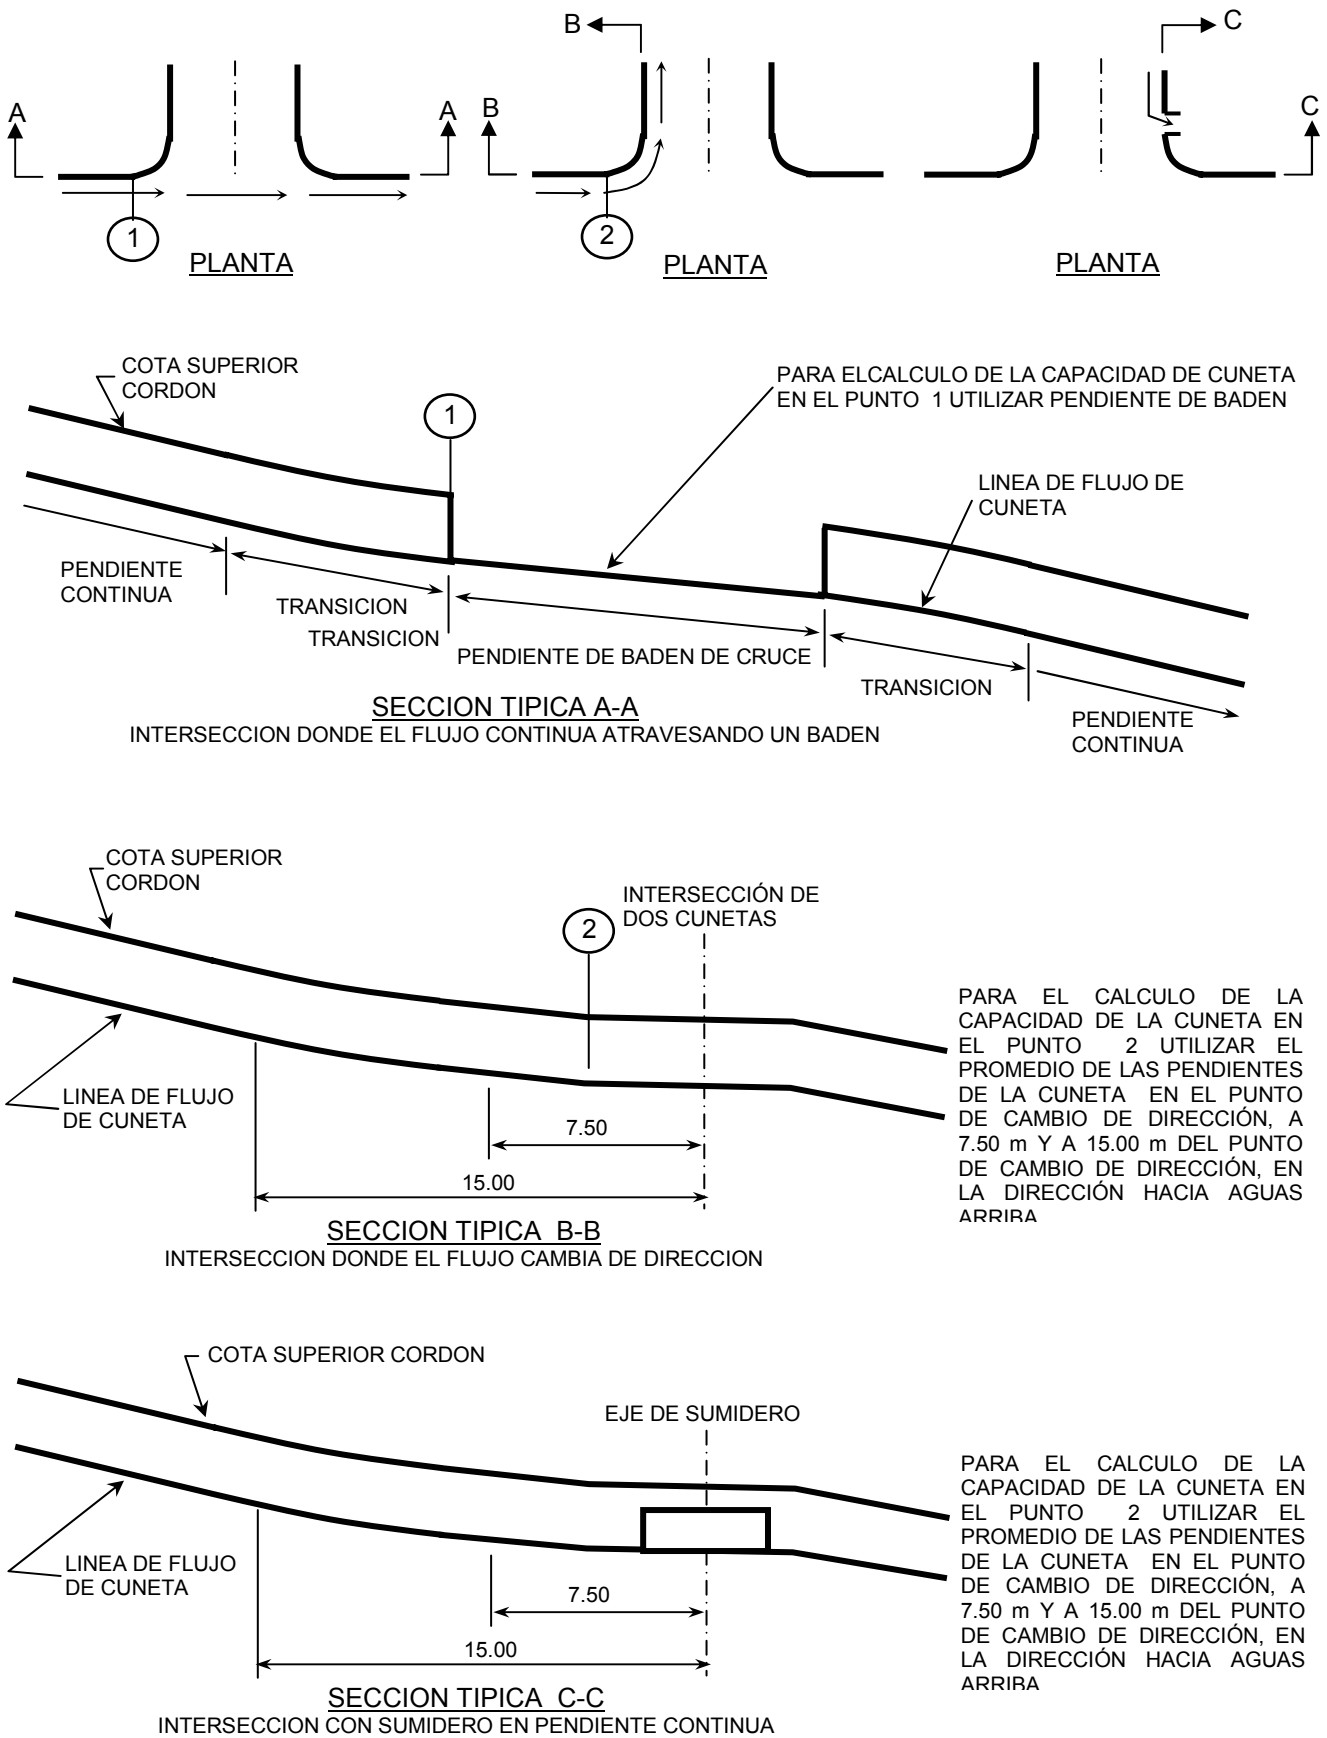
Consideraciones de diseño para el drenaje pluvial en intersecciones de calles.
